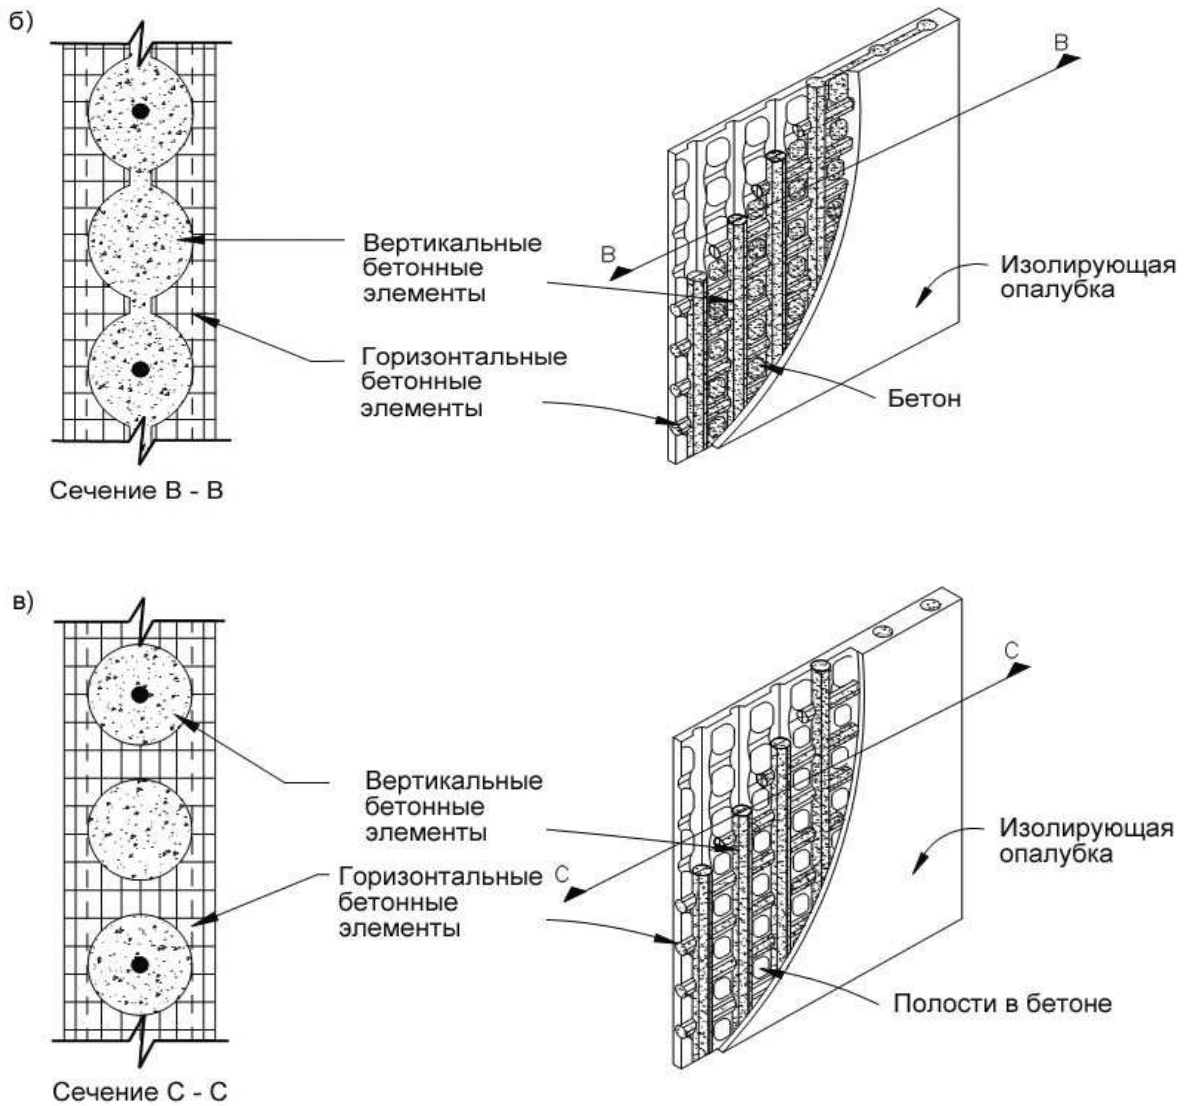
Схемы стен, возводимых из изолирующих опалубок:
